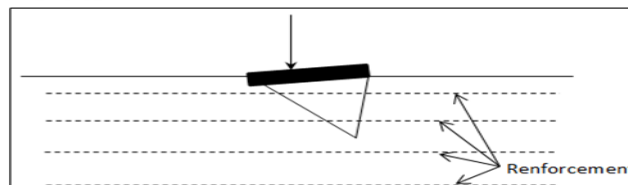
Déformation d'une semelle posée sur sol renforcé sous l'effet d'une charge excentrée
